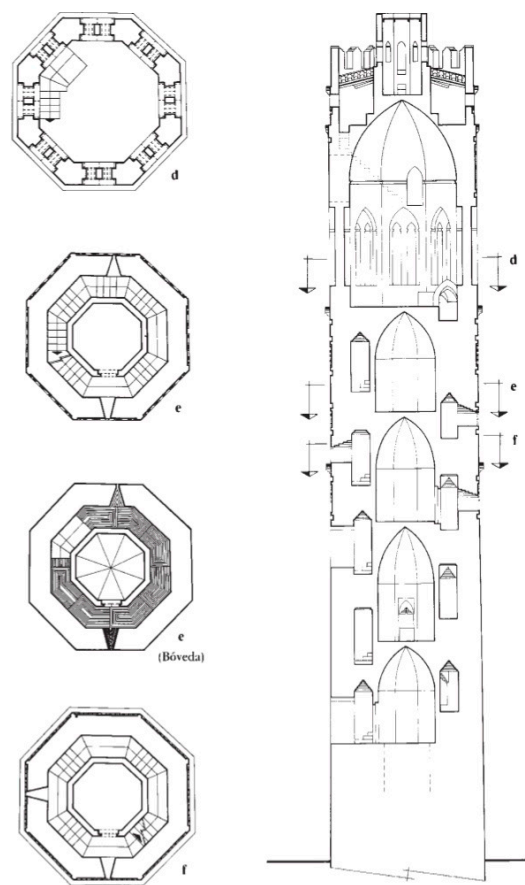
Plantas y sección de la Torre de Santa María de Tauste.
